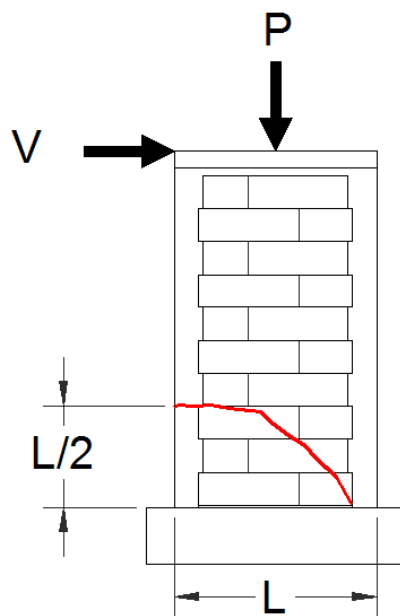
Grieta de flexo-cortante en un muro confinado
